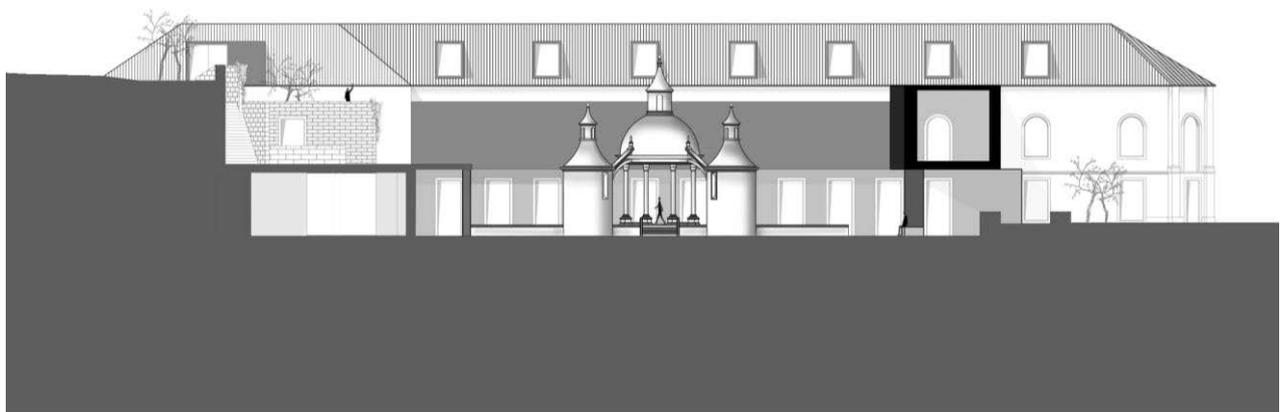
Corte transversal da proposta da Fonte da Manga
